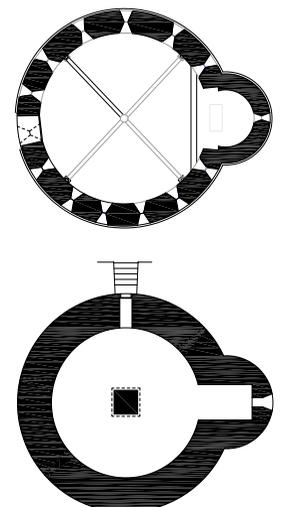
Grundrisse Auer 2012. M 1:400.
